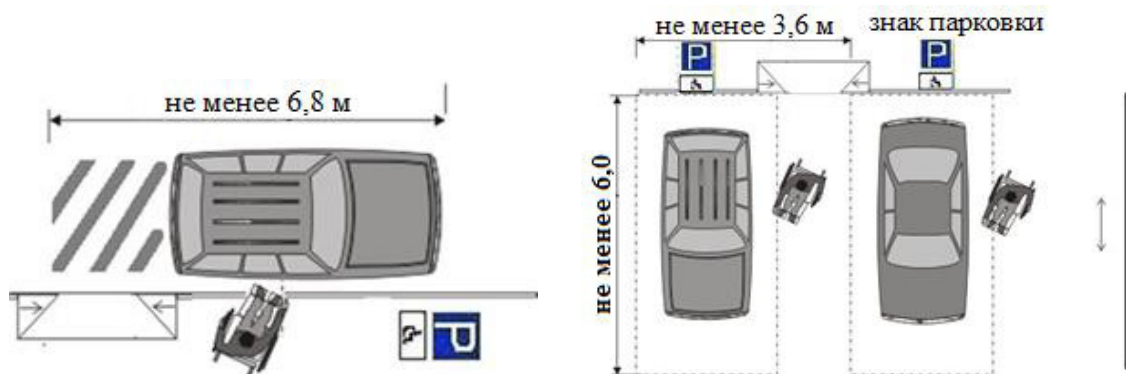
Разметка мест стоянки автомобилей инвалидов на кресле-коляске
